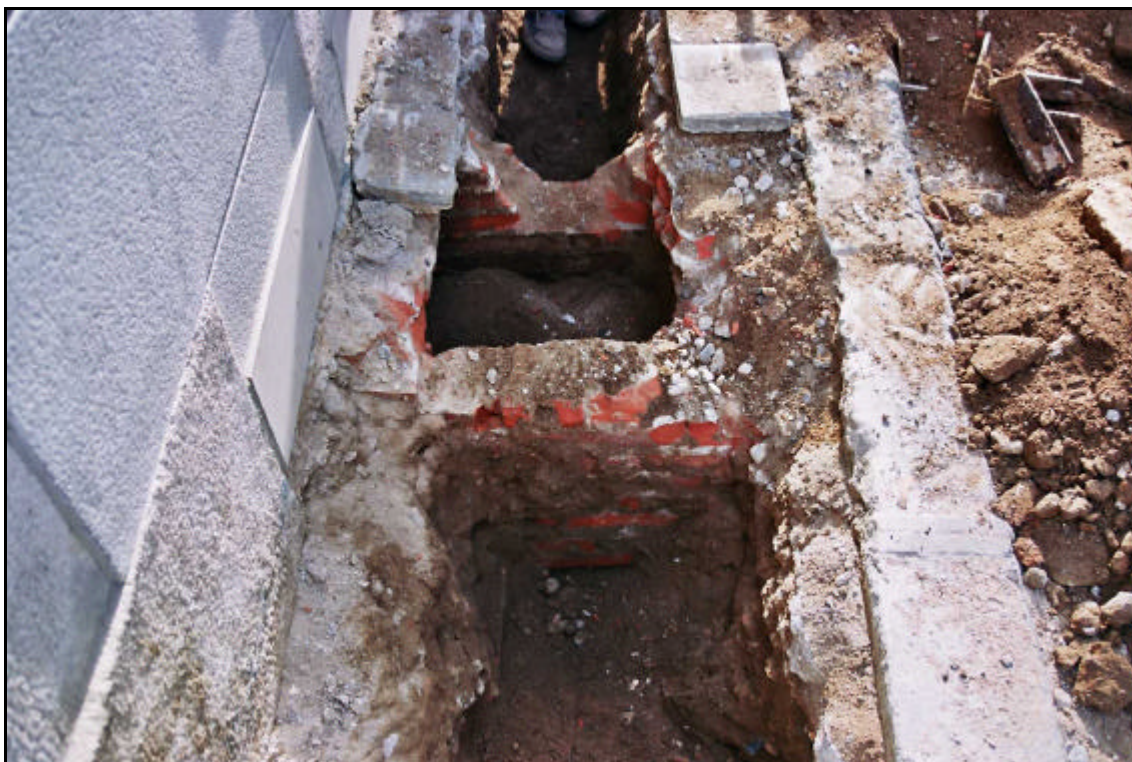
Detall treballs màquina retroexcavadora a la Plaça del Poeta Bosca.
